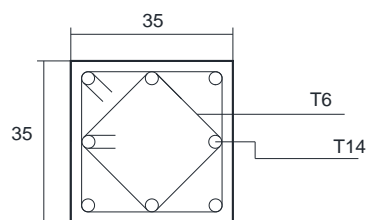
Ferrailage d'un poteau 35x35cm (poutres normales - bâtiment R+7)
